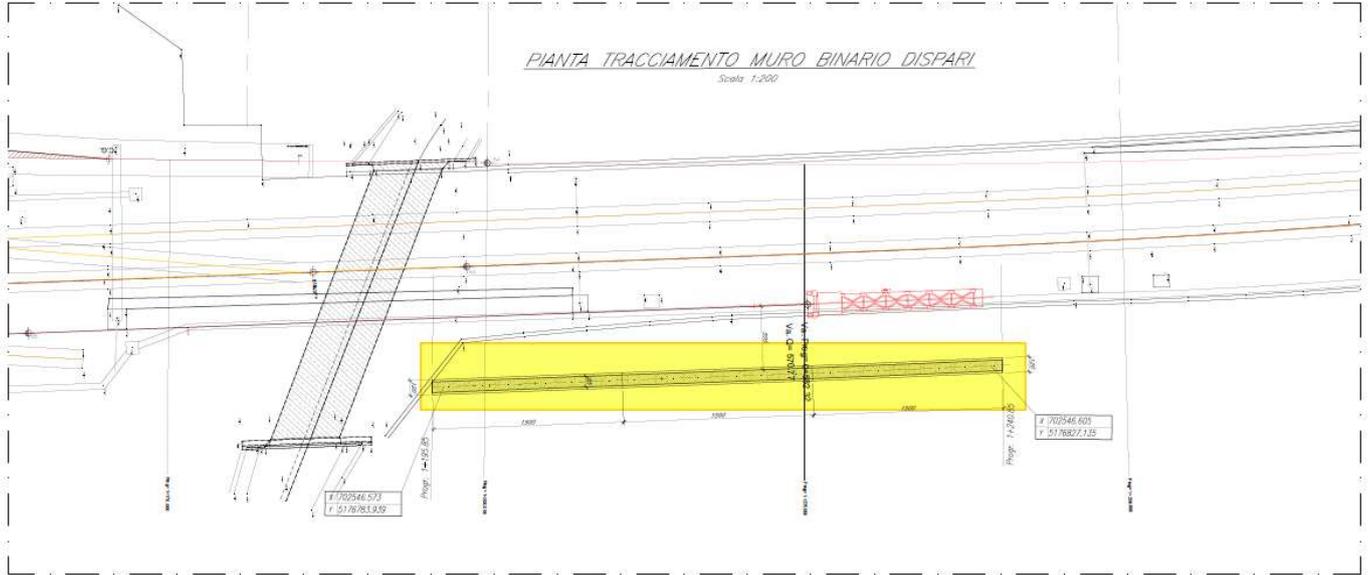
Individuazione Muro in c.a. su fondazioni profonde BD – Planimetria
